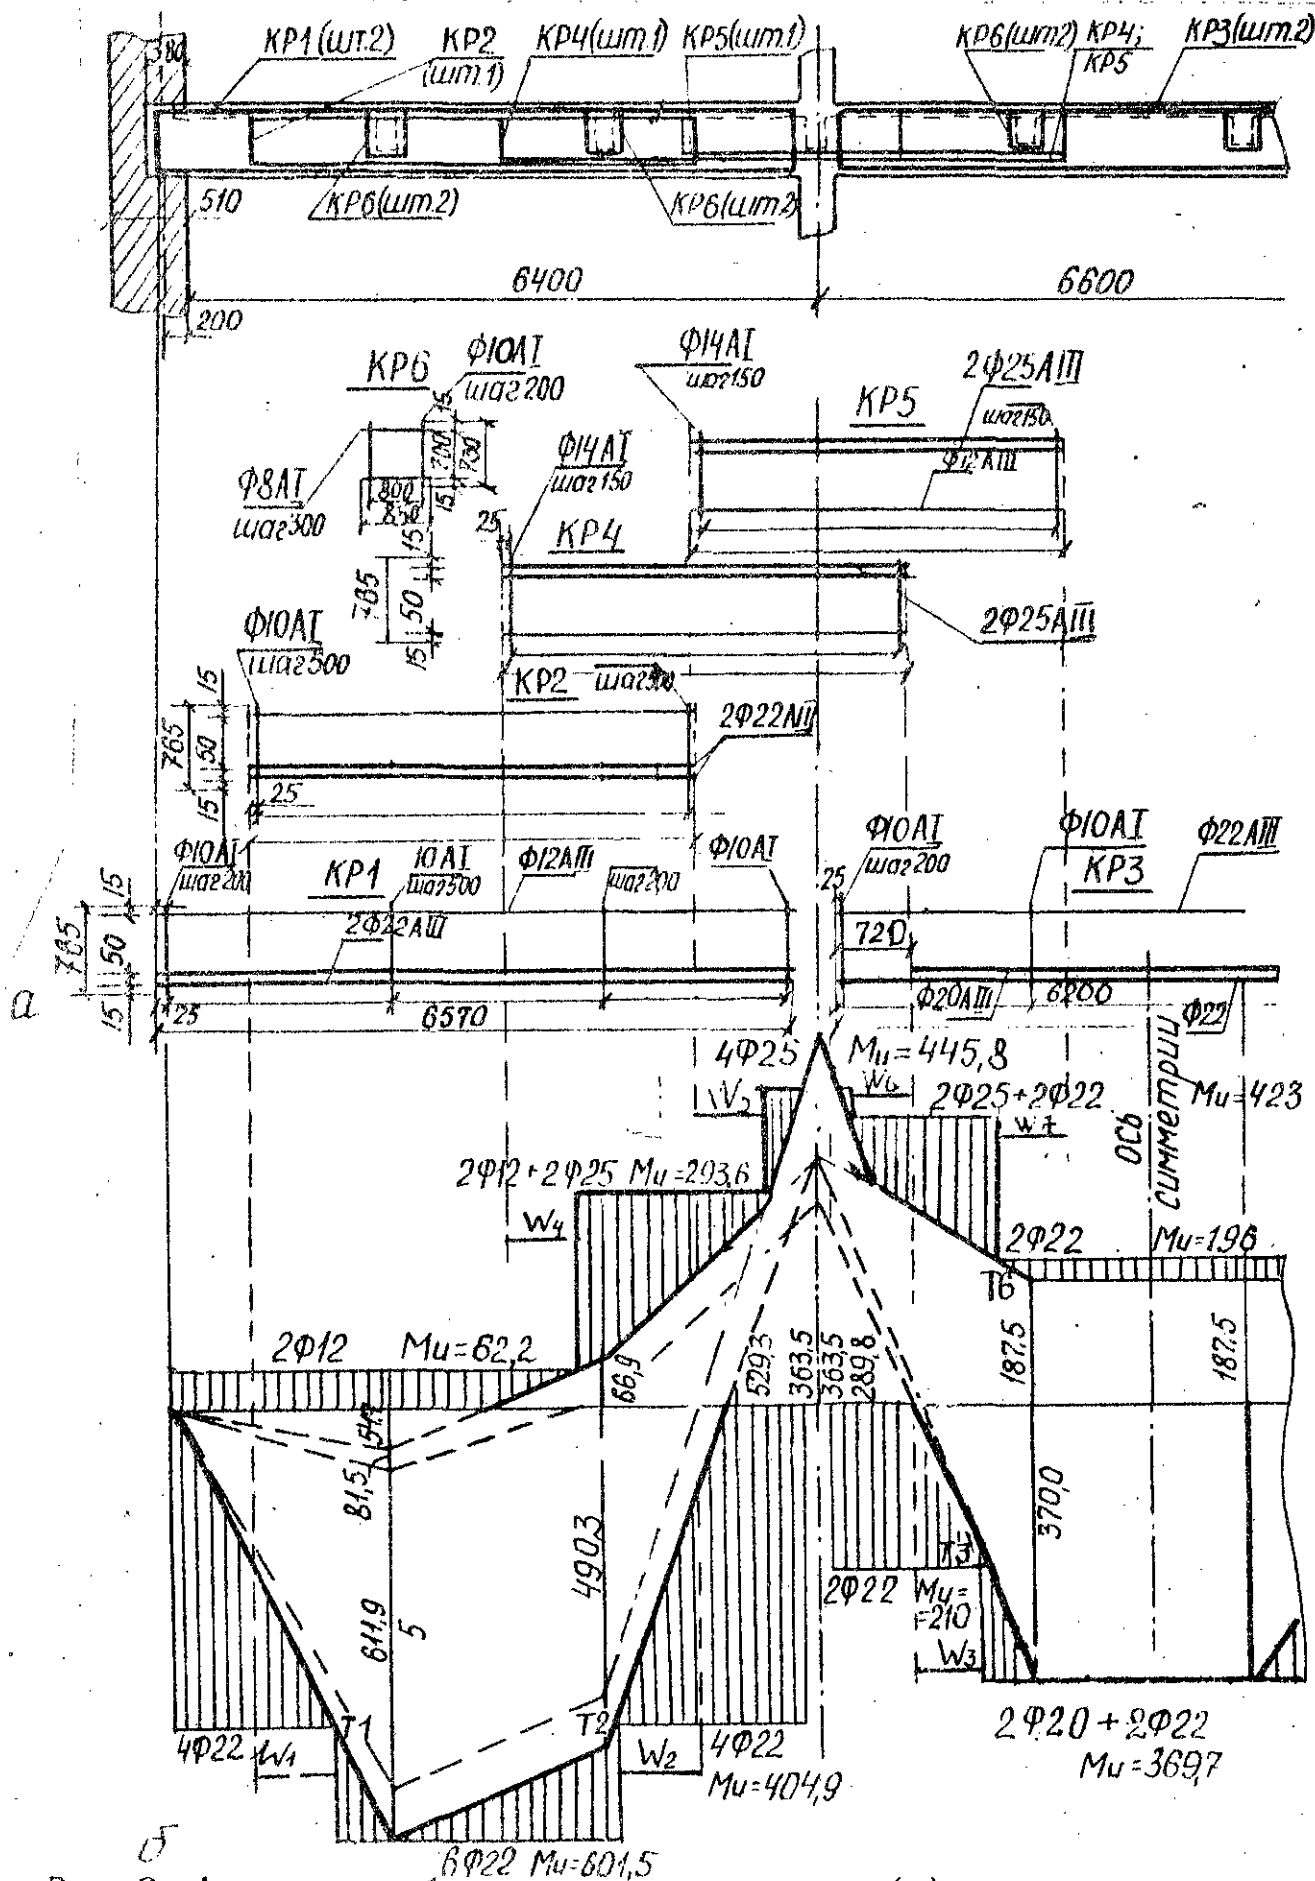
Армирование балки сварными каркасами (а) и эпюра материалов (б)
